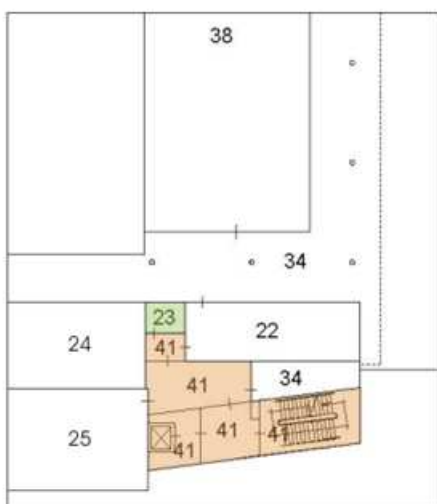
ESTRATTO ELABORATO PLANIMETRICO
